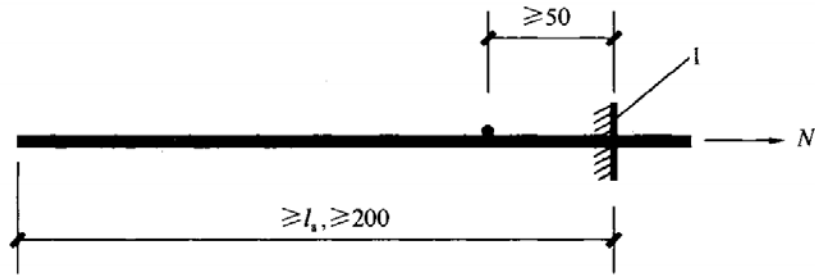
带肋钢筋焊接网纵向受拉钢筋的锚固
